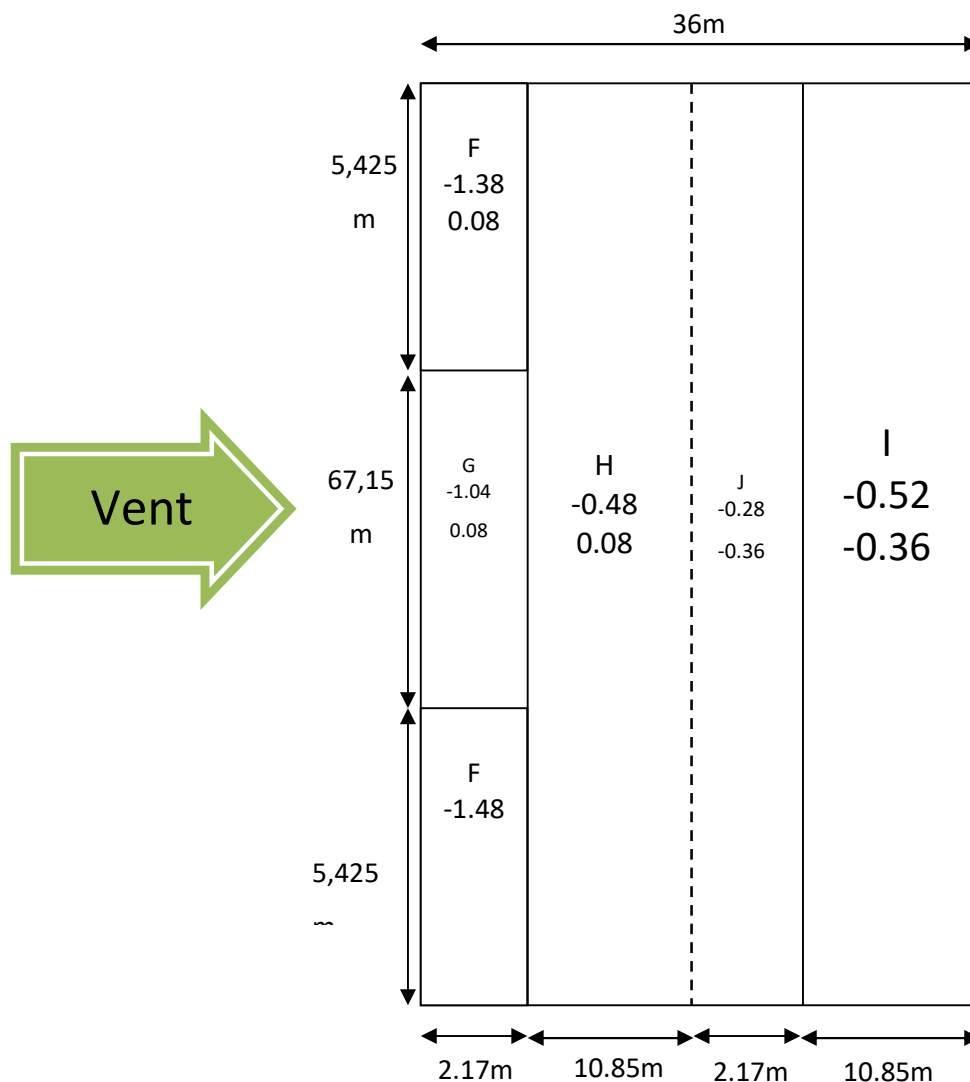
Cpe pour toiture de (Vent sur long-pan).
